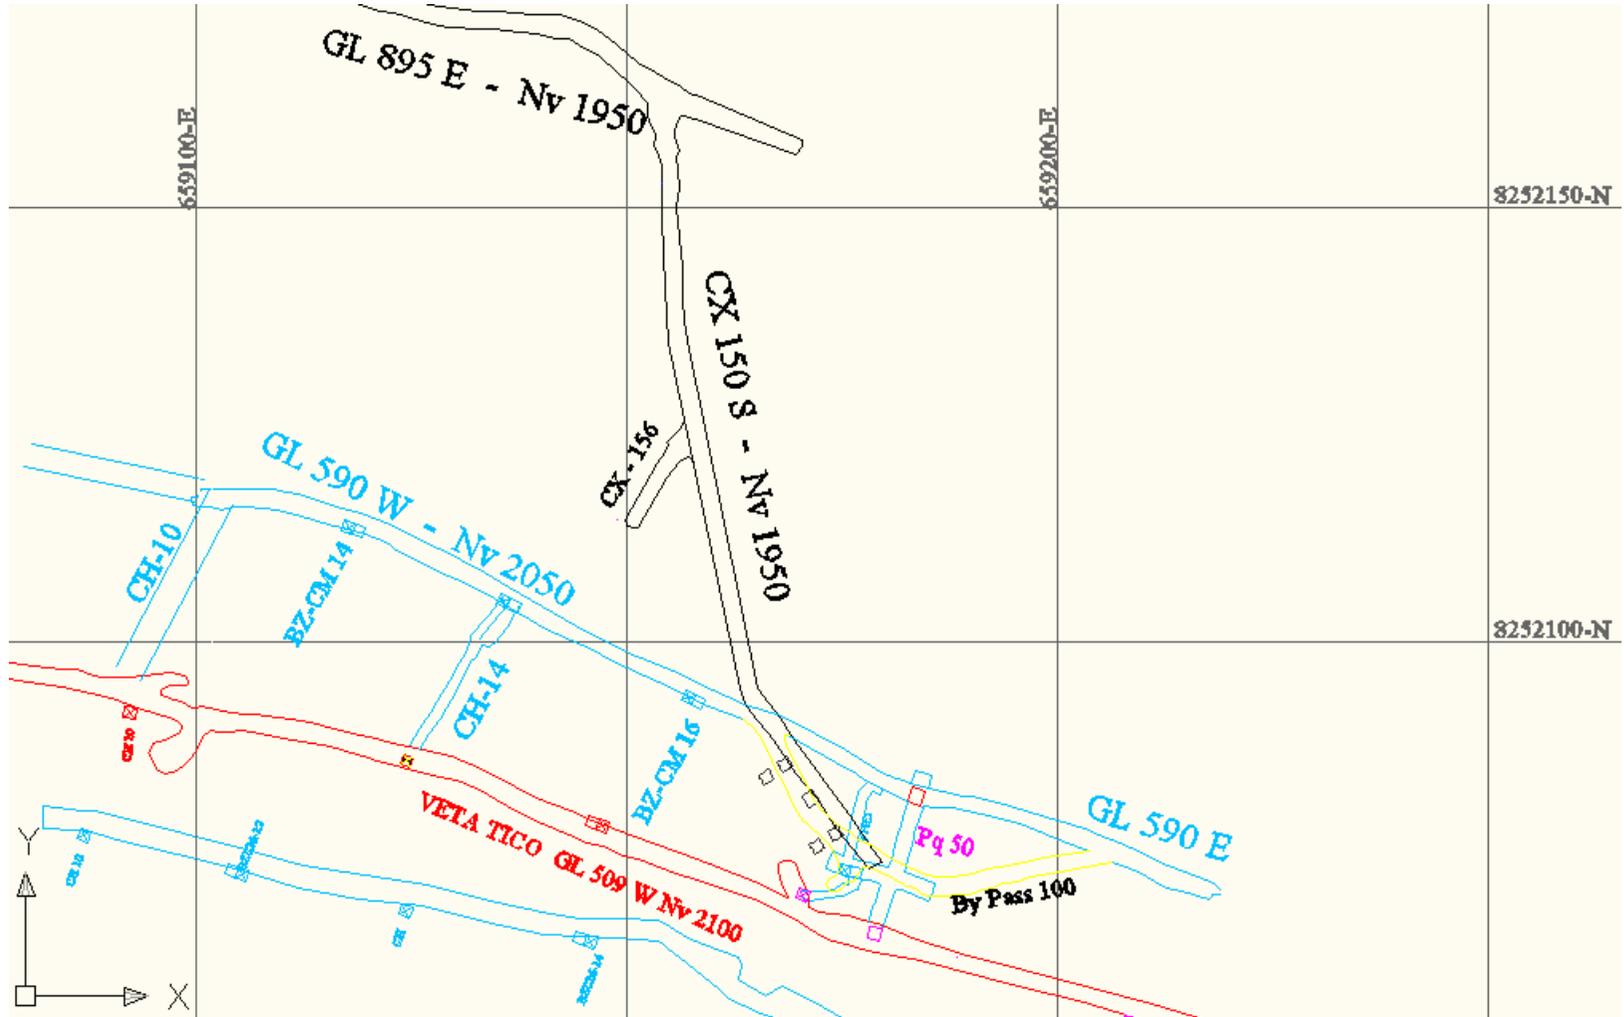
vista en planta del diseño de labores mineras a programarse
